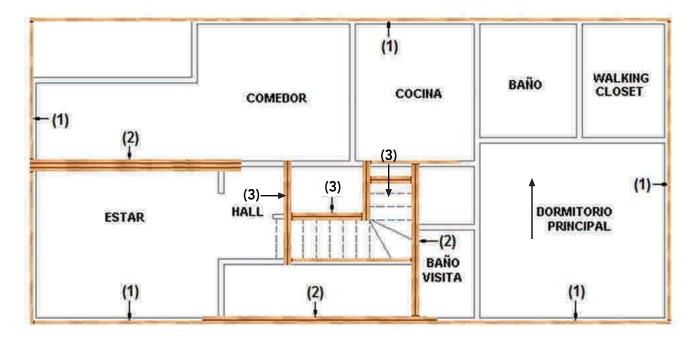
31: Plano planta de vigas perimetrales (friso) (1), viga compuesta (2), necesarias según cálculo para reforzar al envigado por distanciamiento de los apoyos y viga cabezal (3) como refuerzo en el perímetro de la escotilla de la escalera.
